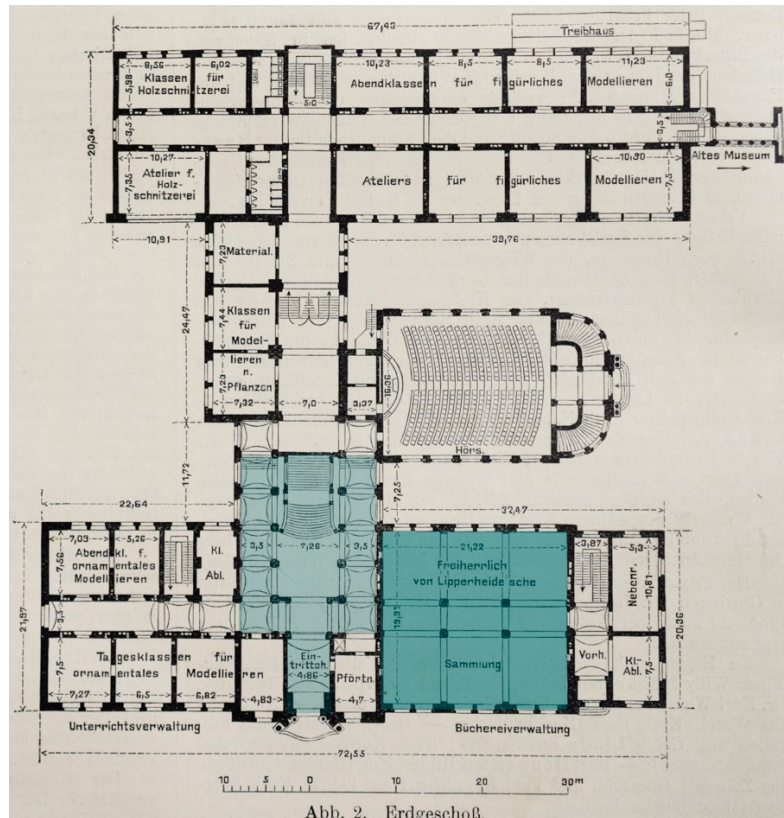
Grundriss der Unterrichtsanstalt, koloriert der Bereich der Gemäldehängung
